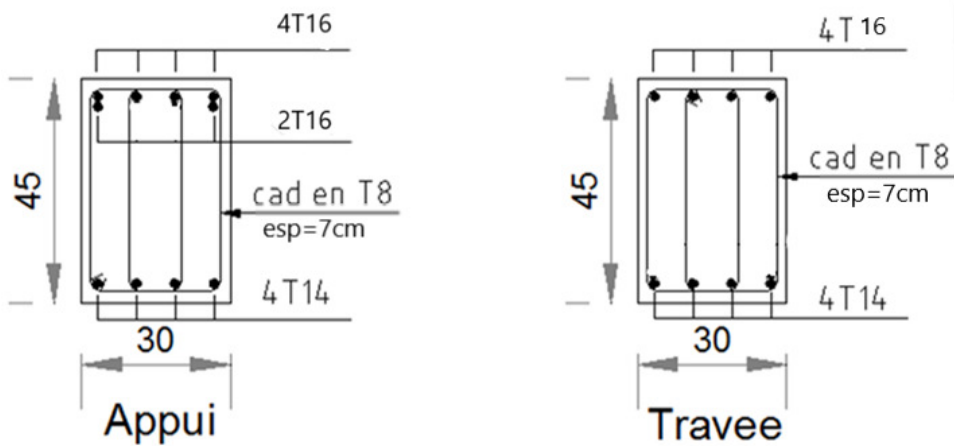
Ferraillage des poutres principaux en travée et sur appuis
